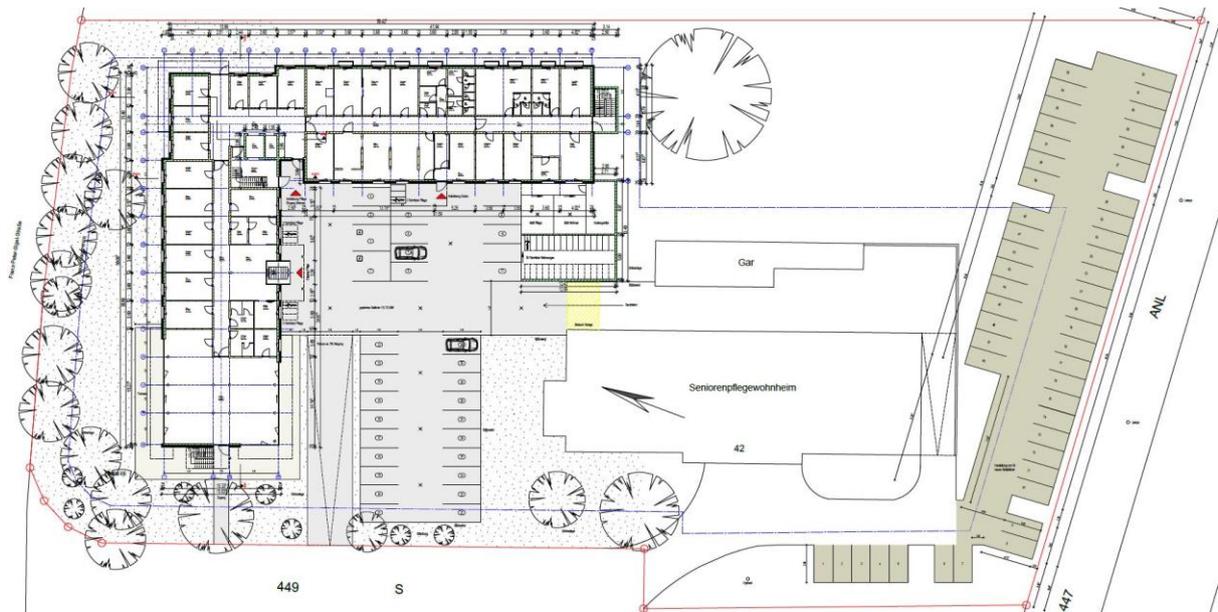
Lageplan des geplanten Neubaus – Aktiv Wohnbau GmbH, ohne Maßstab
